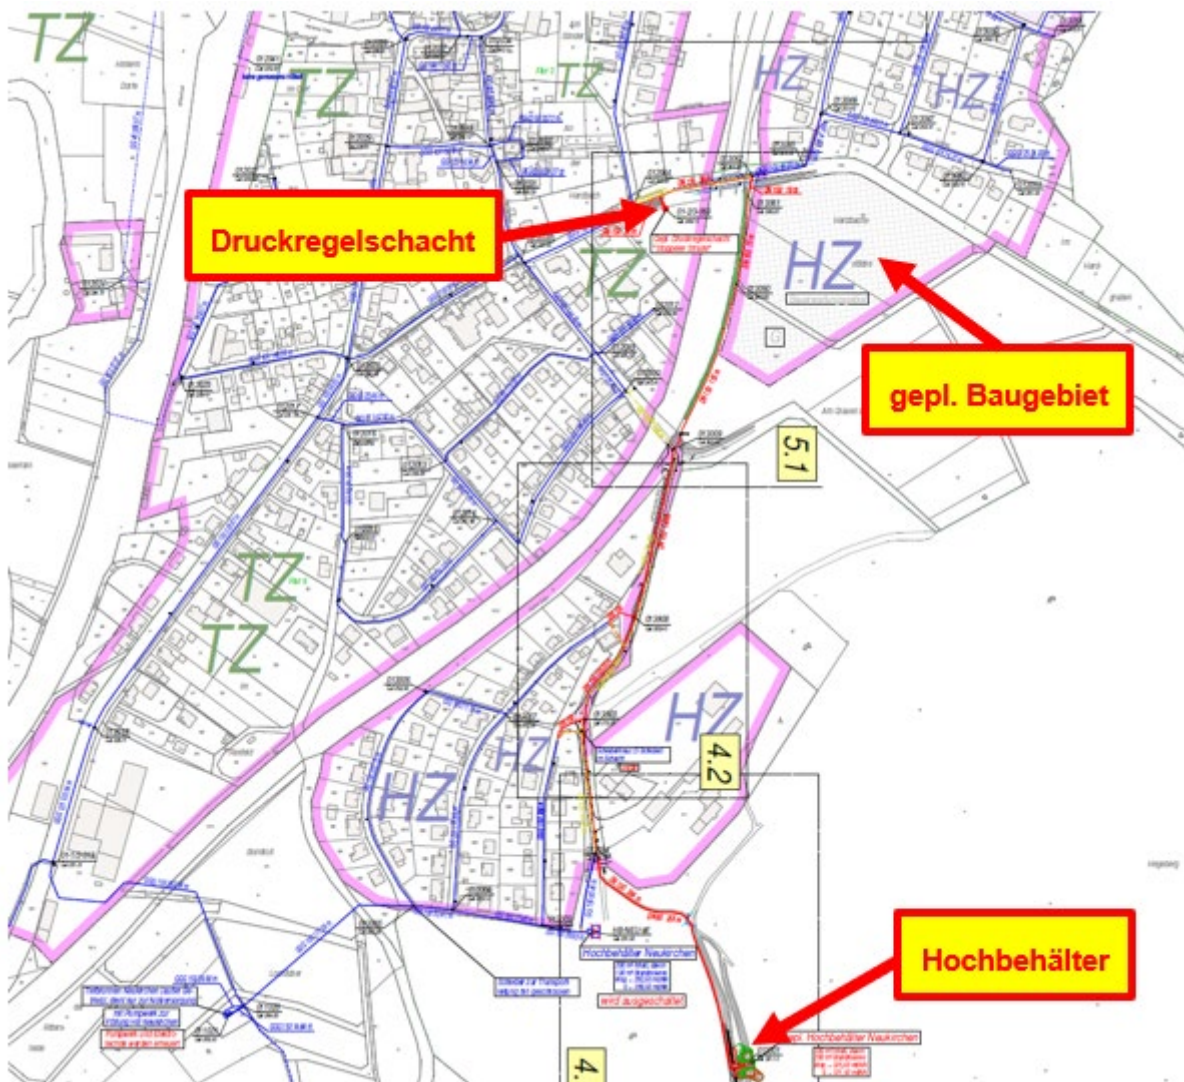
Auszug Übersichtslageplan Rohrnetz Neukirchen [Quelle: Tiefbautechnisches Büro Köhl GmbH]
